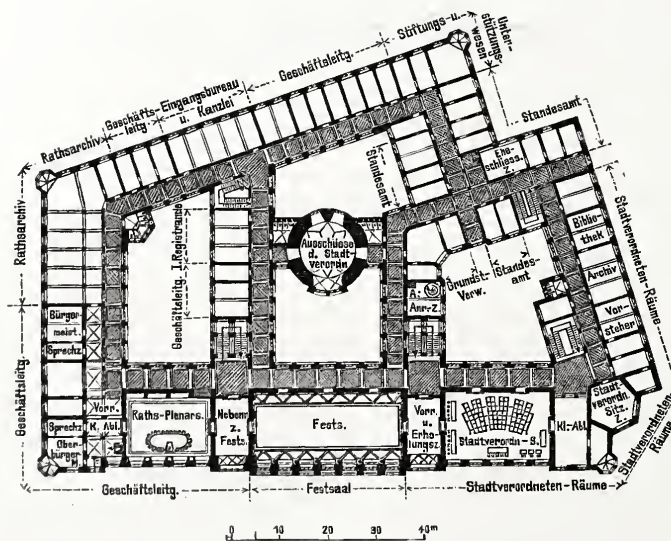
Grundriss vom Hauptgeschoss.
